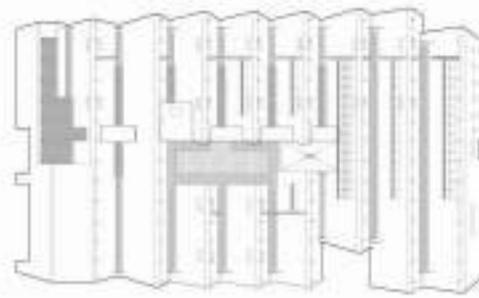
Planta de Techos - Design Strategy & Research Center. Plano de The System Lab (Plataforma Arquitectura, 2017)
